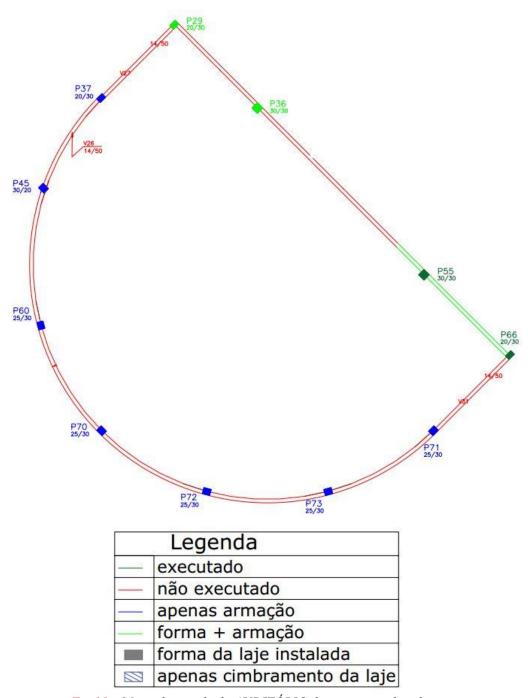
Mapa iluminado do AUDITÓRIO do pavimento de cobertura.
